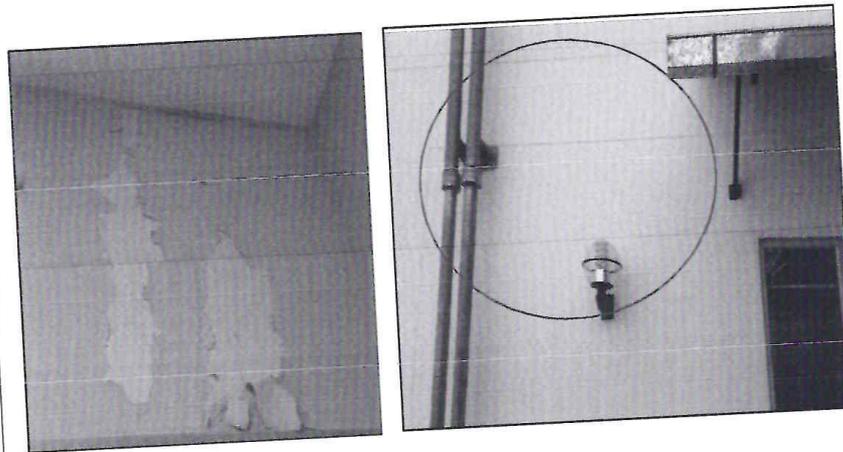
12/09/2023: Se constata la filtración de agua en paredes en el área de gastroenterología, debido a la falta de techo de plancha metálica.
